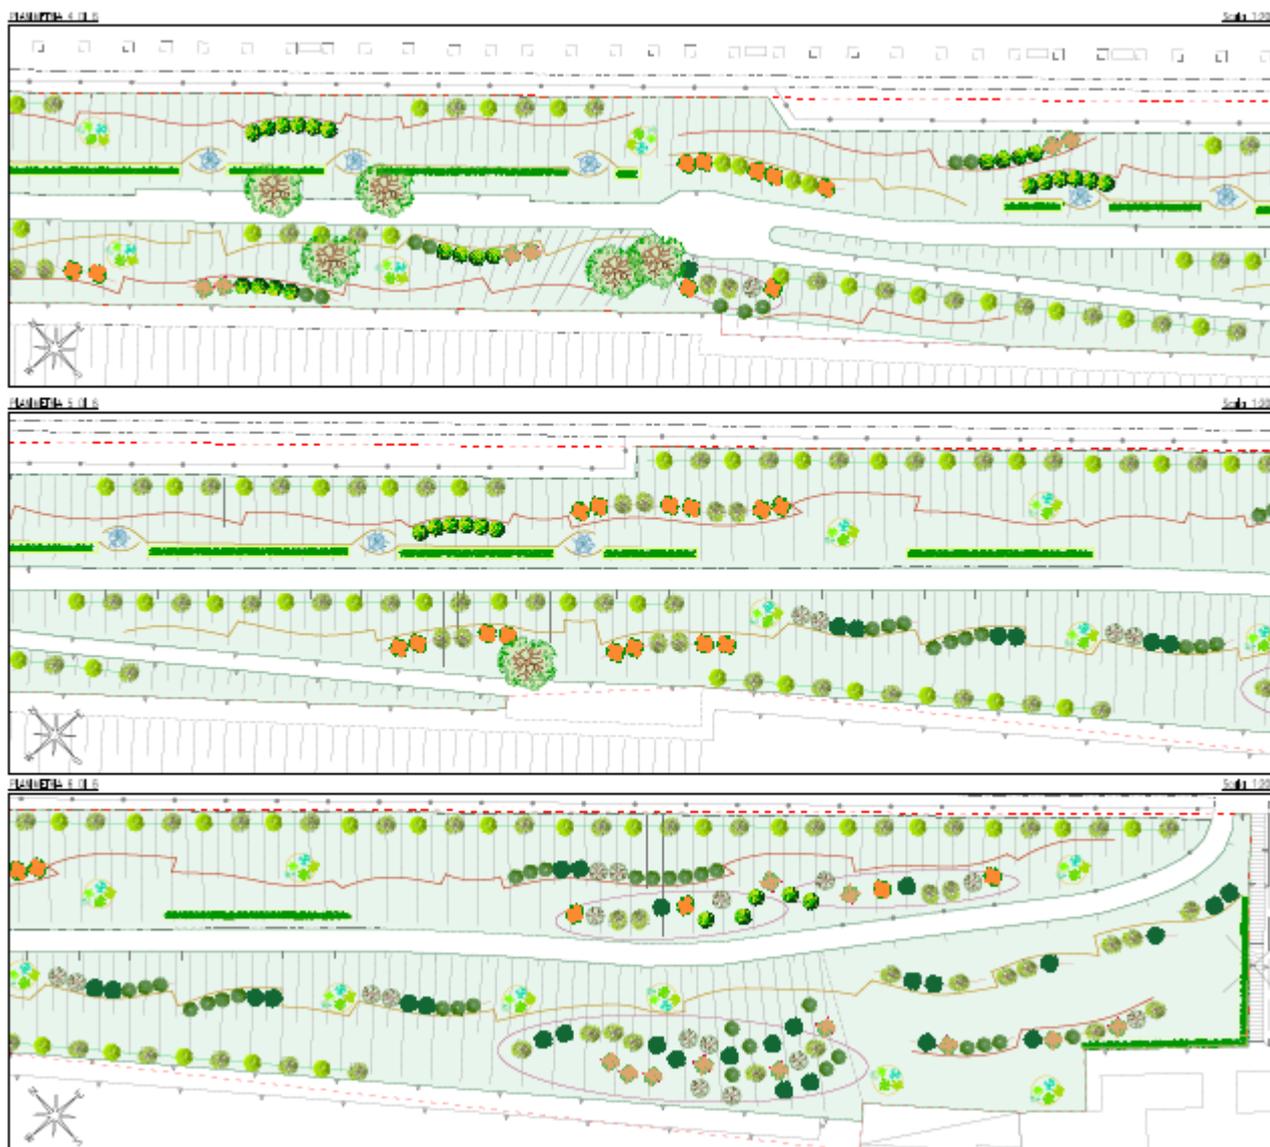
Estratto elaborato Planimetria opere verde (2 di 2)
